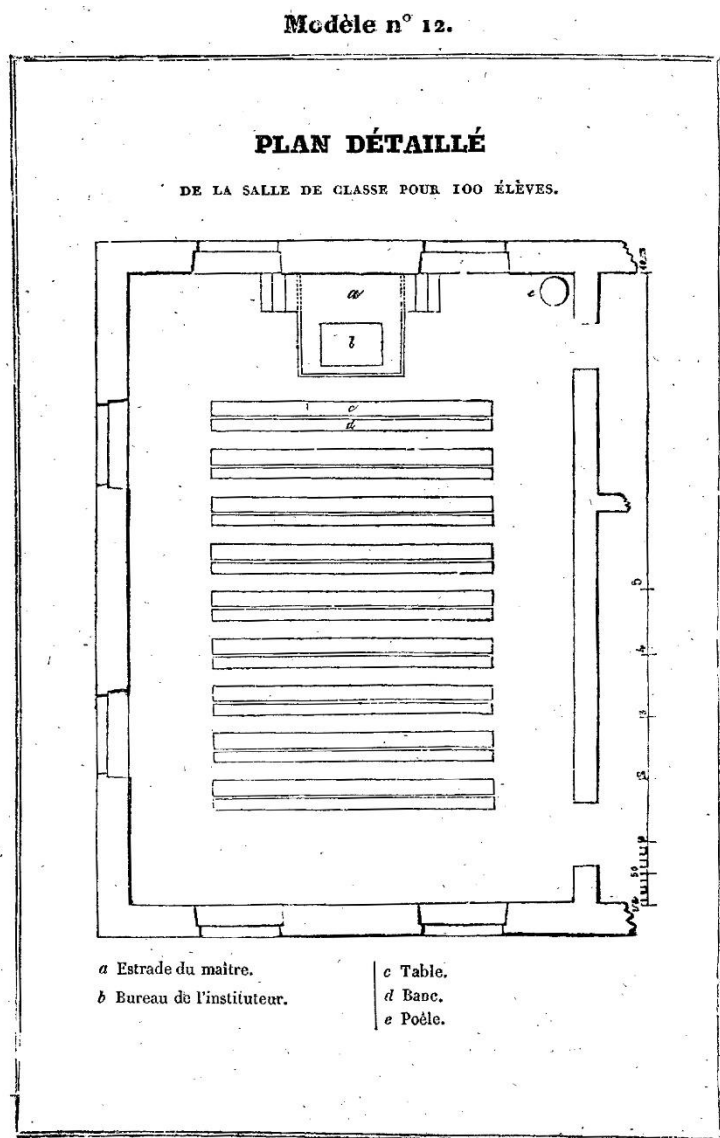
Plan détaillé de la salle de classe pour 100 élèves. In *Code de l'instruction primaire contenant l'historique de la législation primaire depuis 1783, la loi du 28 juin 1833, l'ordonnance du roi du 16 juillet 1833, les circulaires et instructions ministérielles pour l'exécution de la loi* (2e édition). Paris : P. Dupont, 1834, modèle n° 12.
